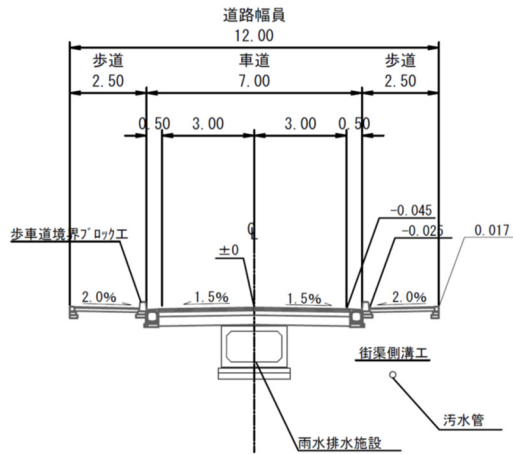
(3) 標準断面図(区画道路 12-1 幅員 12.0m)
